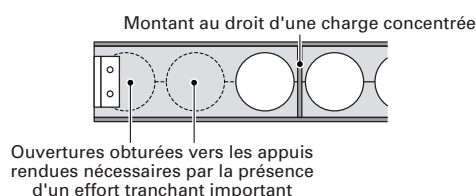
Dispositions courantes dans les poutrelles alvéolaires
